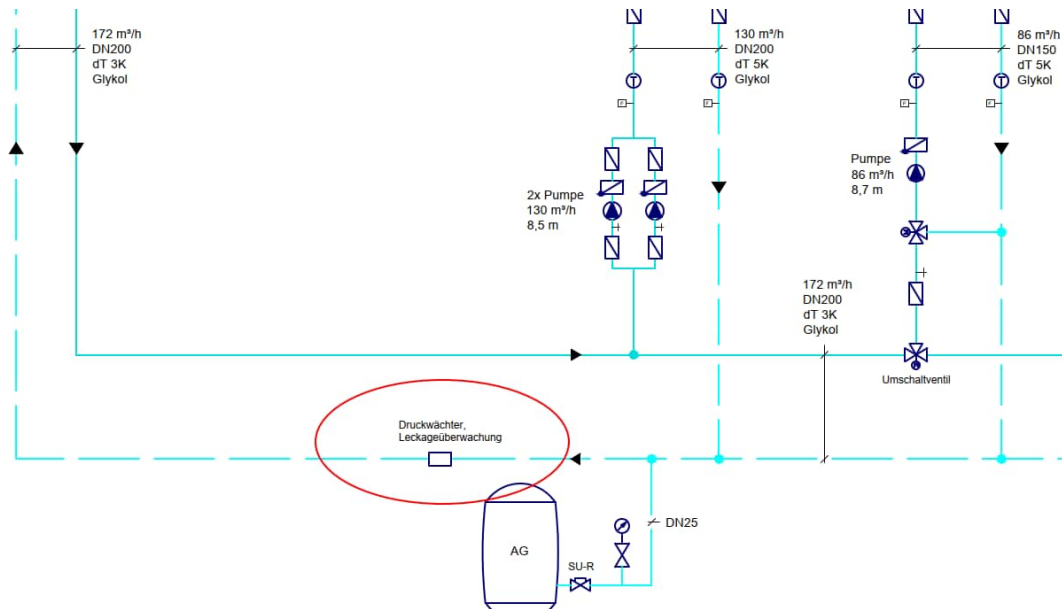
Planausschnitt Funktionsschema – Darstellung Leckageüberwachung
